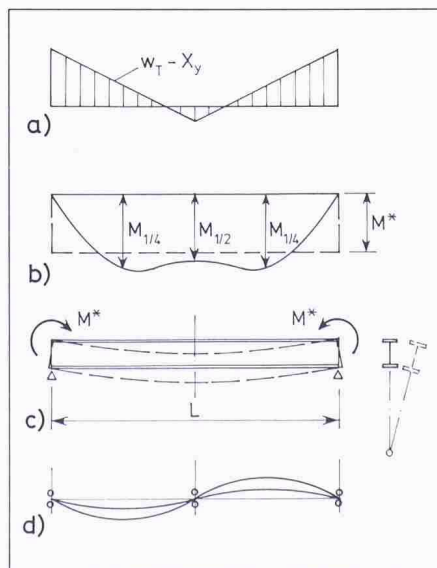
Versteifungsträger unter Querwind, a) Windlast, b) Biegemomente, c) Aufriss und d) Grundriss
